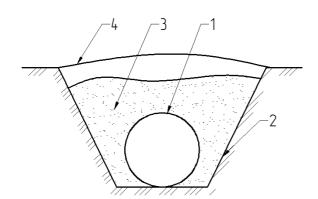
Способ балластировки газопроводов закрепленным грунтом: 1 — трубопровод; 2 — траншея; 3 — закрепленный грунт; 4 — рекультивируемый слой грунта
